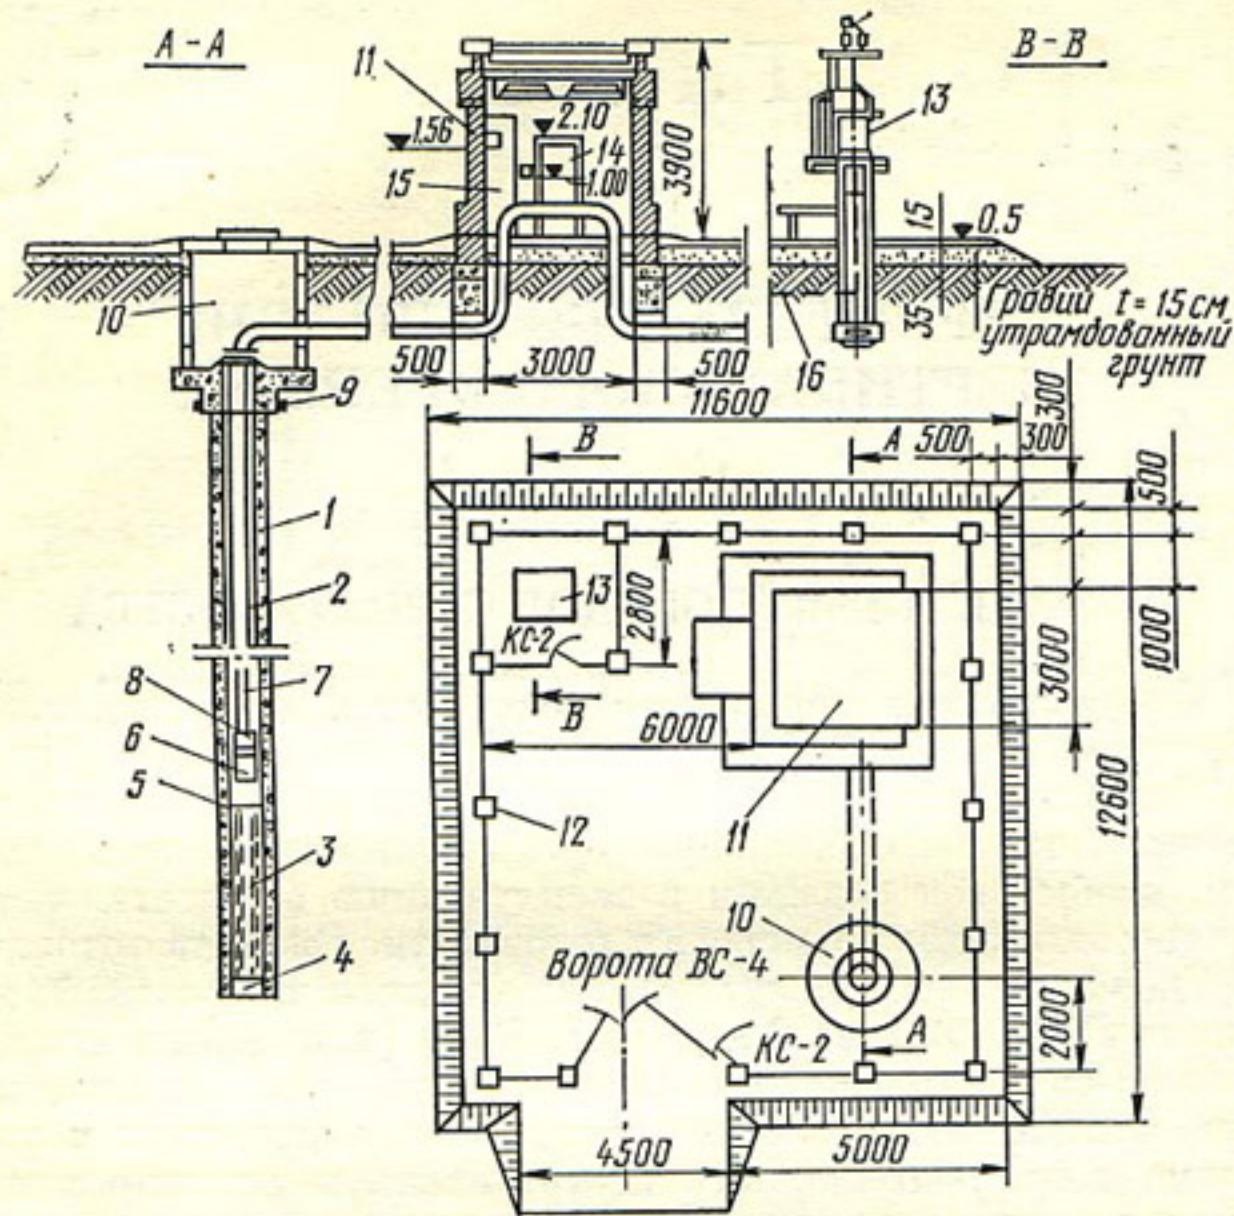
Схема скважины и план площадки вертикального дренажа (по ВСН-П-8-74):
